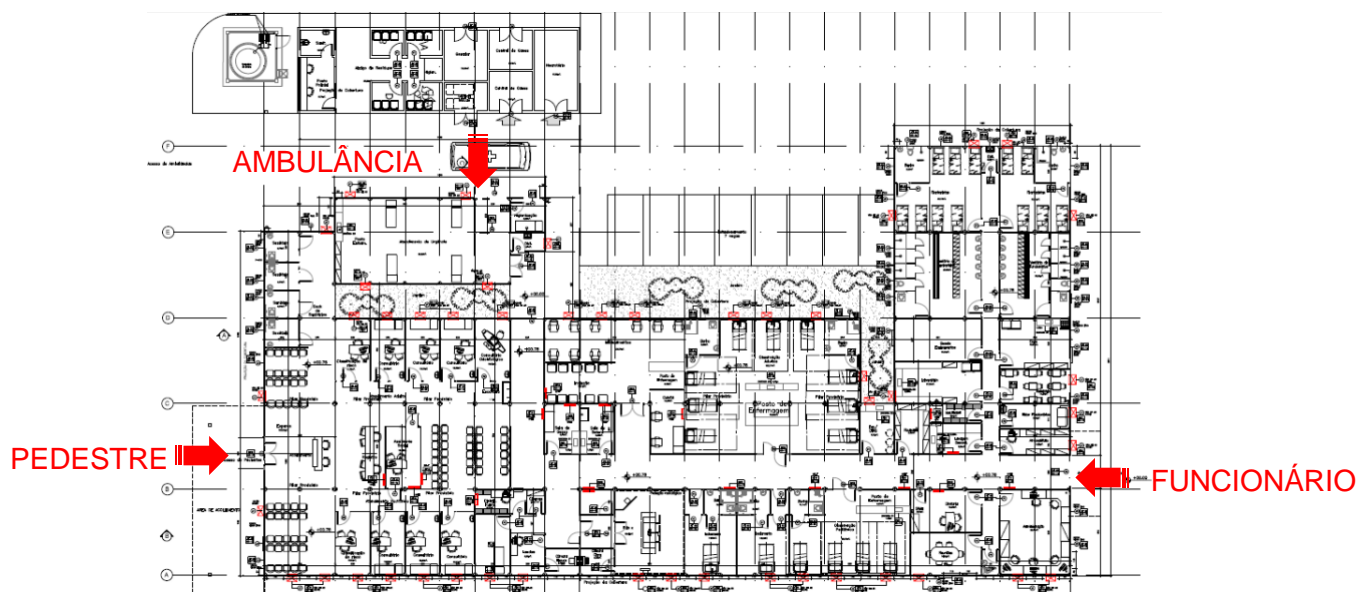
Planta Baixa com Acessos da UPA Samambaia/DF.
